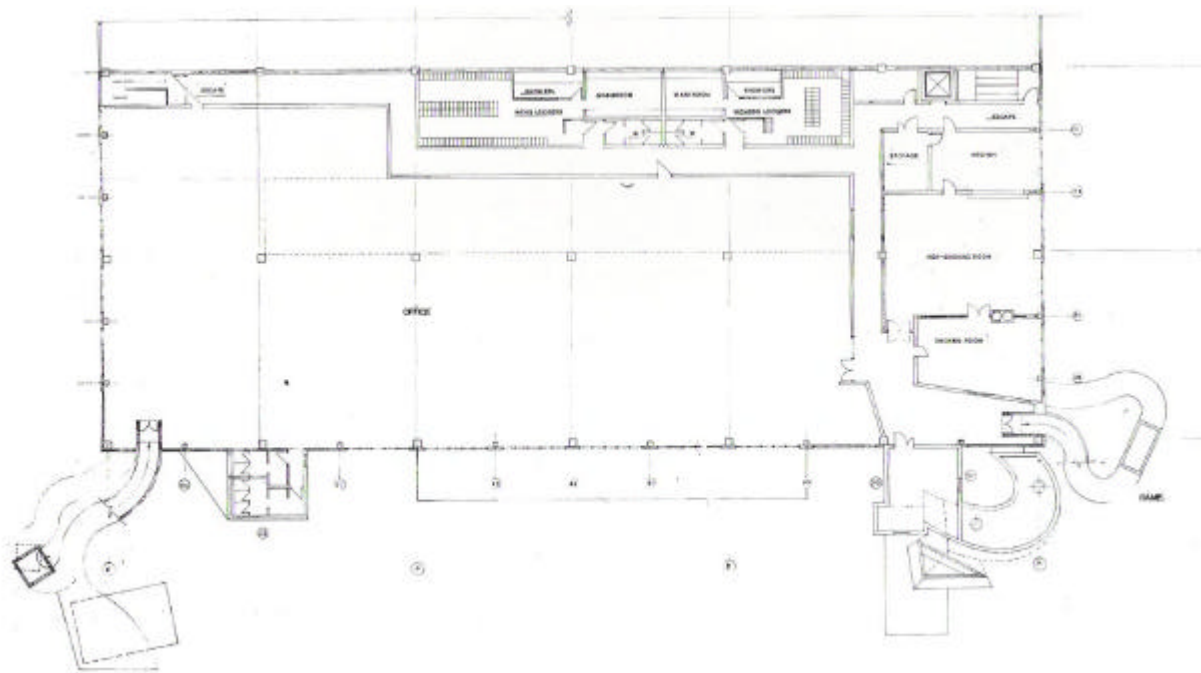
Frank Gehry, Fabrikationshalle, 1987-1989, Grundriß Obergeschoß
